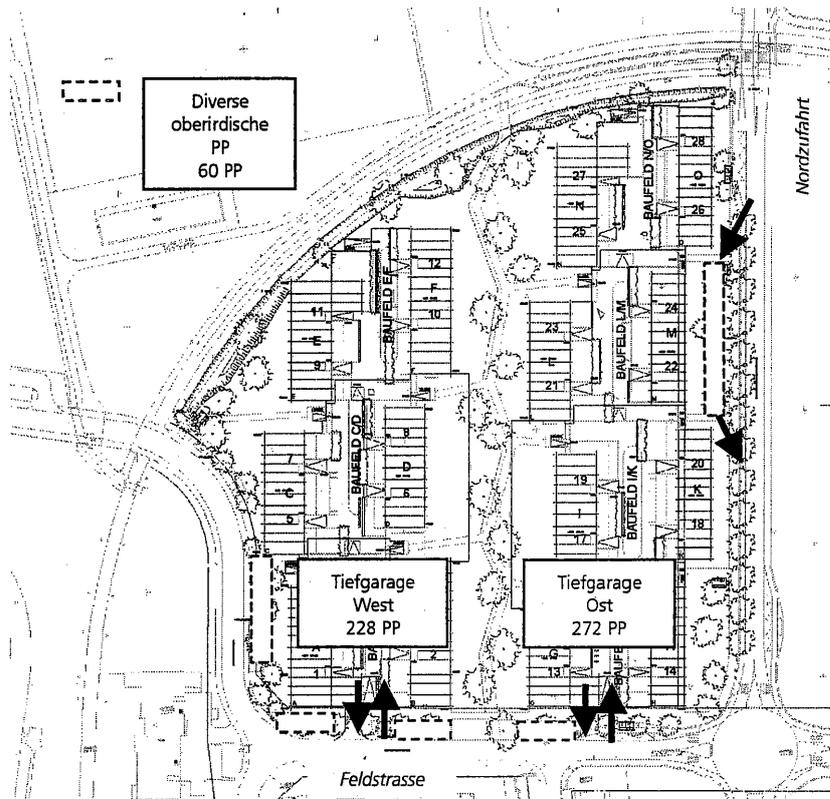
Parkierung auf dem Areal Feldhof West gemäss Bebauungsplan
